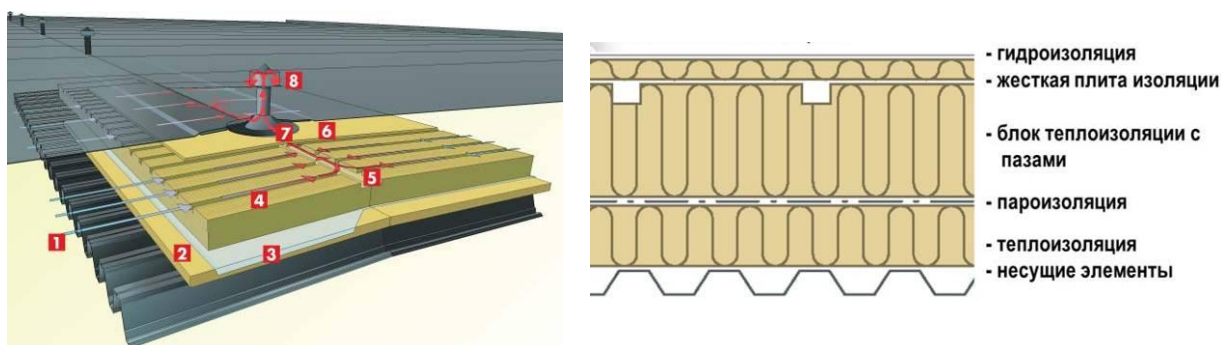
Совмещенная вентилируемая кровля системы PAROC:
